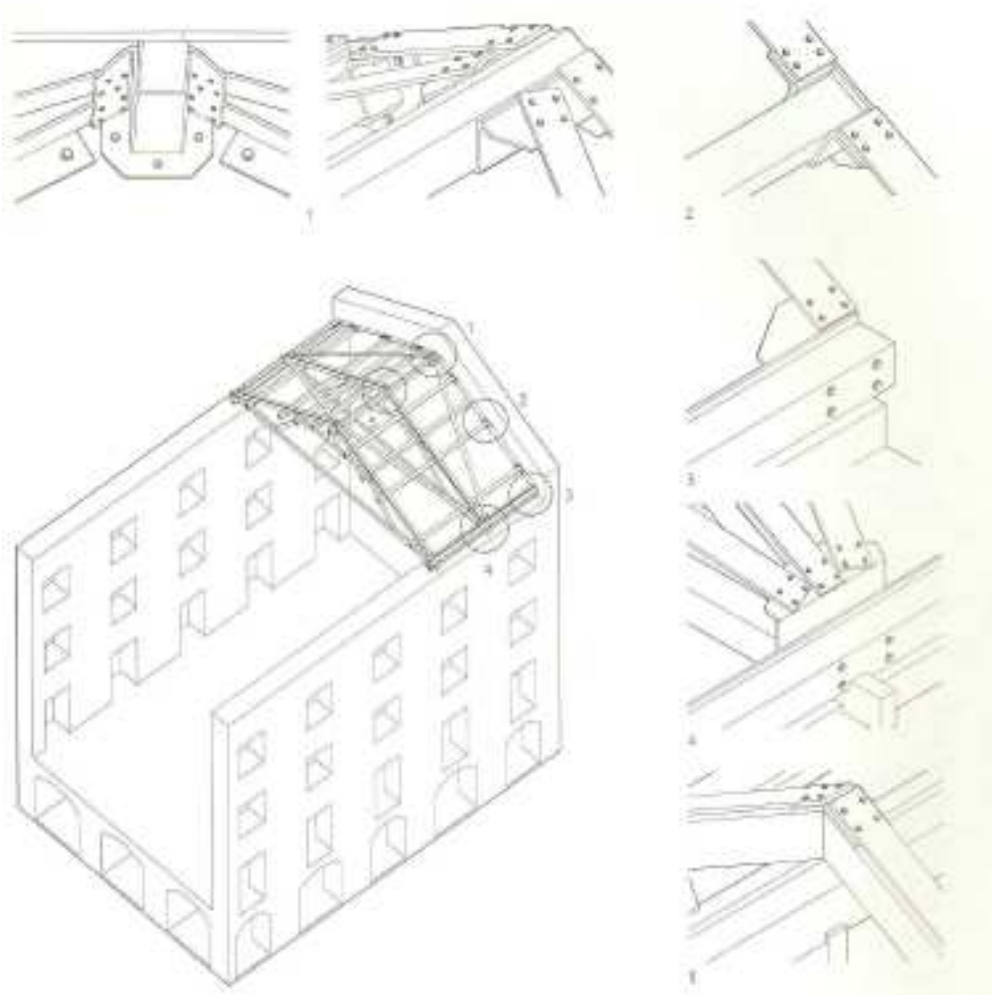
Reforço de contraventamento através da ligação de diagonais entre as asnas
